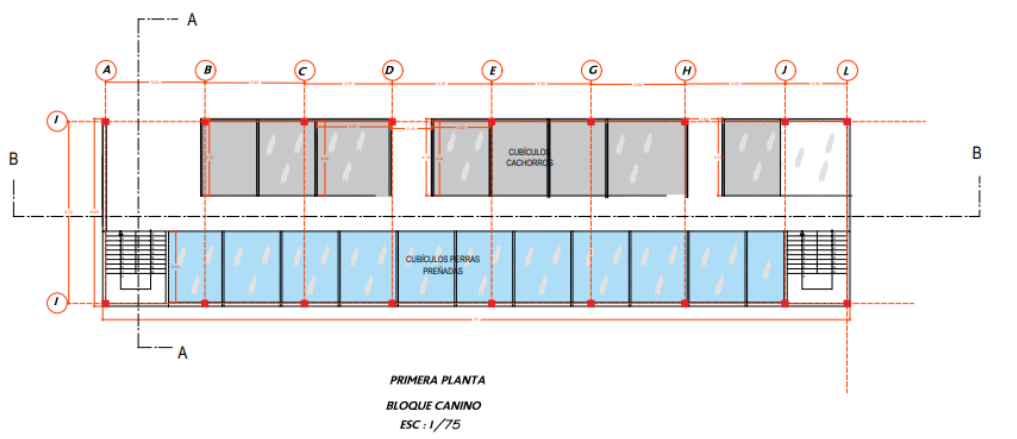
Plano Arquitectónico Área de Jaulas Caninas Bloque 1
